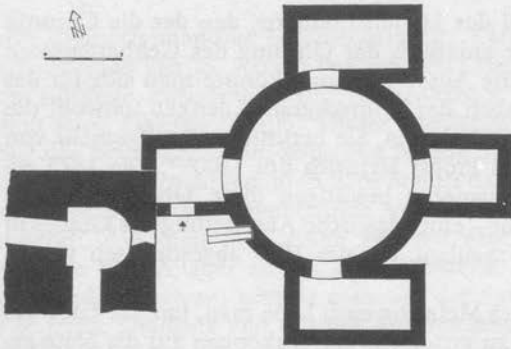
Konstanz, St. Mauritius, nach 940, Rekonstruktion des Grundrisses II (Variante, zugleich möglicher Umbau), M. 1:500.
